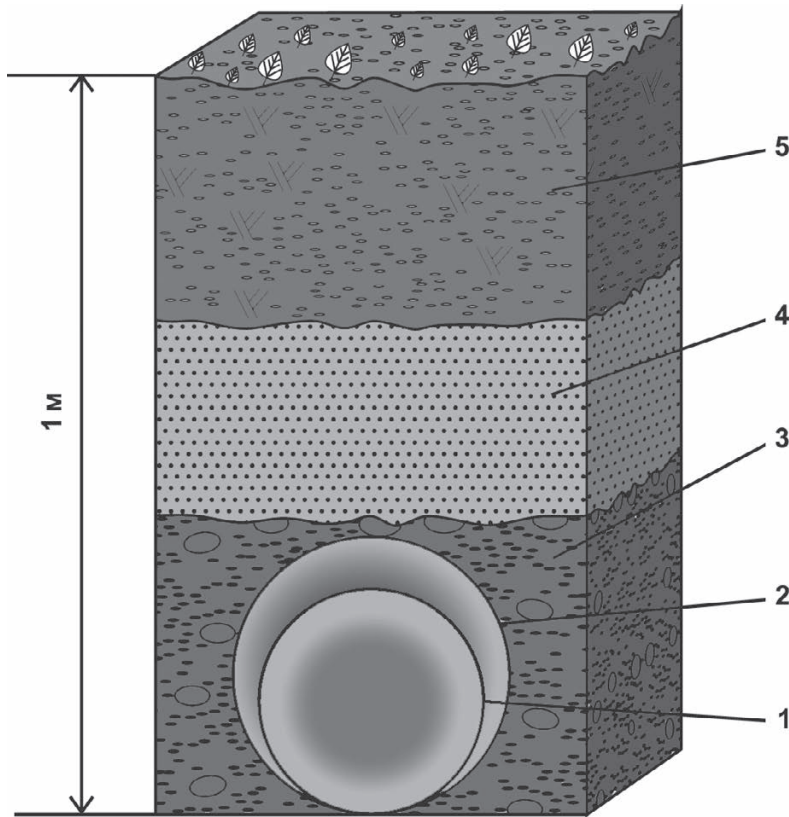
Укладка трубопровода в траншею: 1 — технологическая труба (используется полипропиленовая канализационная диаметром 11 см); 2 — водопроводная труба; 3 — щебень; 4 — утеплитель (пенопропилен); 5 — грунт
